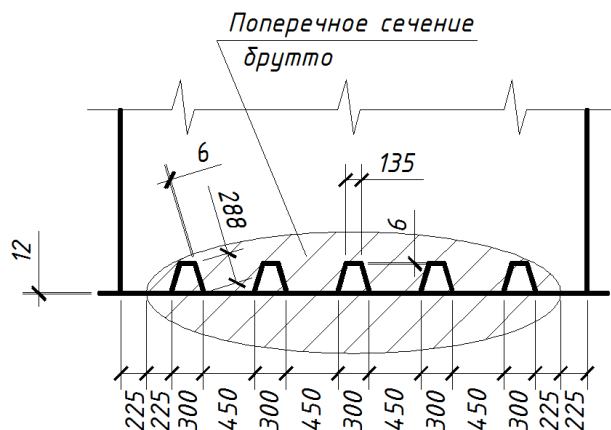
Поперечное сечение брутто ортотропной плиты
